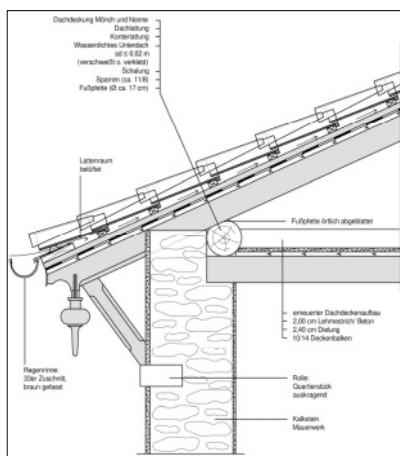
Geplanter Aufbau der Dachhaut Villa Garovaglio, Verfasser
